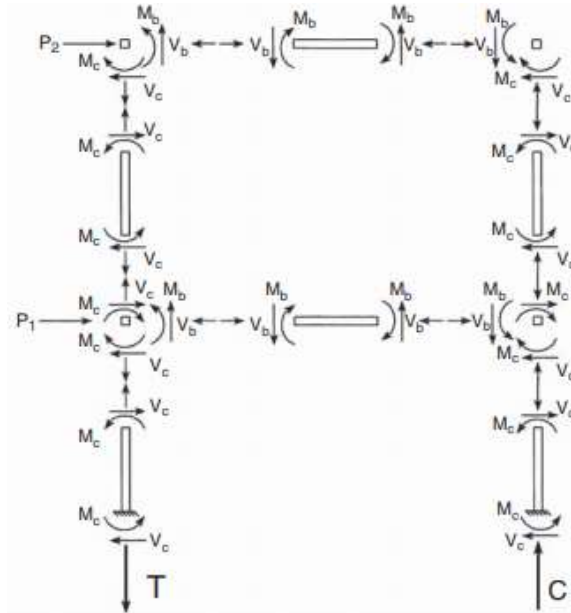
Fuerzas internas de vigas, columnas y zonas de conexión para un SMF (Michael Bruneau, 2011)
